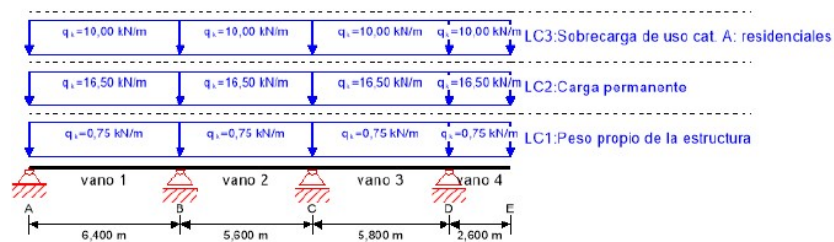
Esquema estático del pórtico tipo con voladizo.
